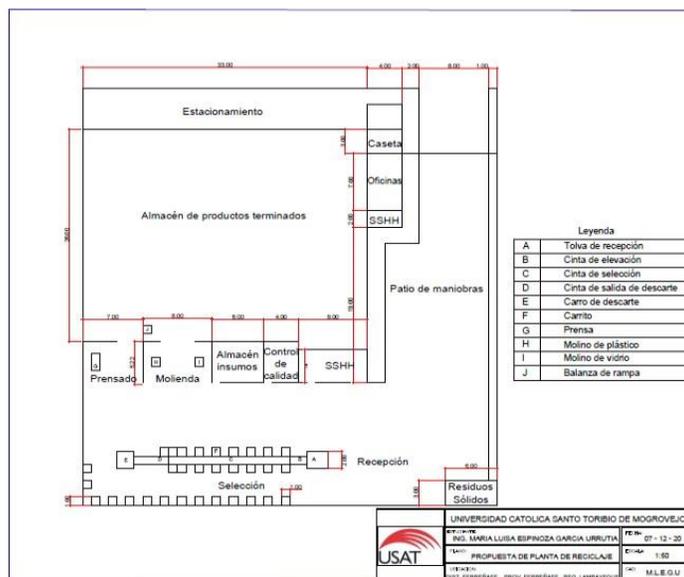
Plano de la planta de reciclaje propuesta. Fuente: autores.
